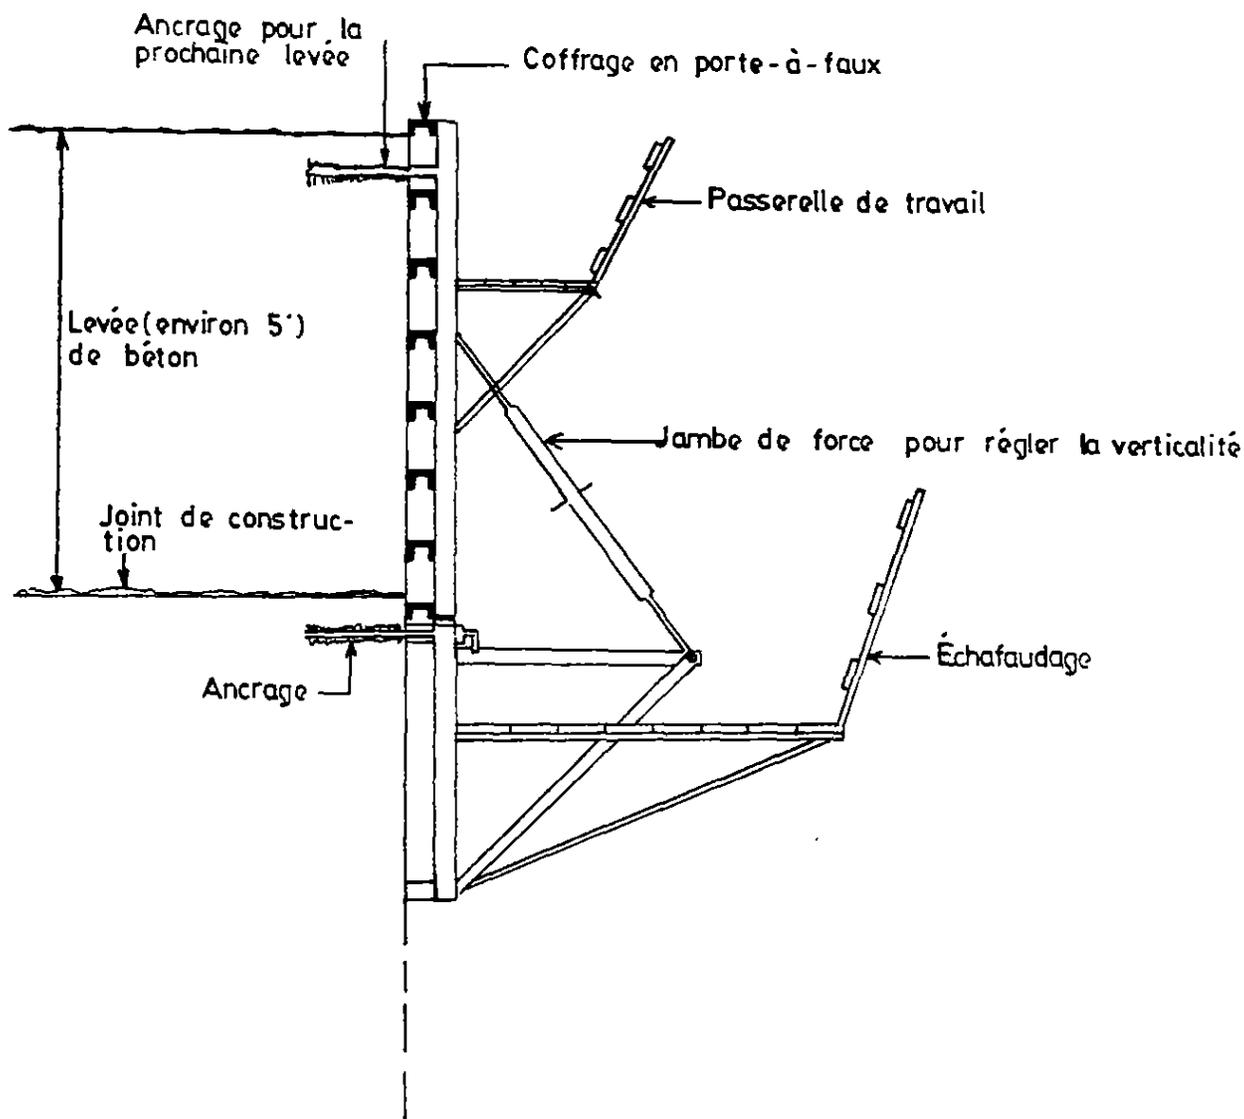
Coupe type d'un coffrage grimpant utilisé en Travaux Publics
